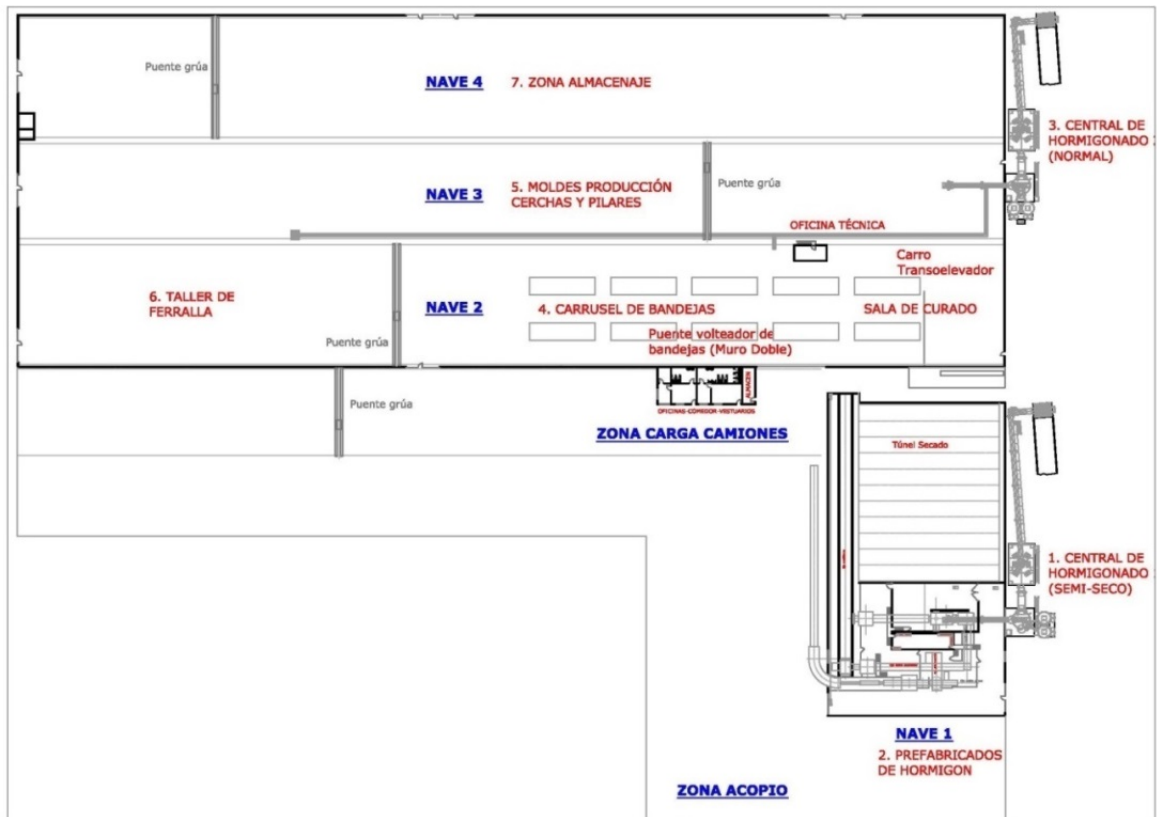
Planta esquema de fábrica PAVI<sup>6</sup>
